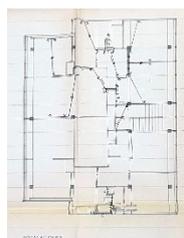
Planta Instalaciones B-3-3. 1964. Fuente: Archivo Municipal da Coruña
